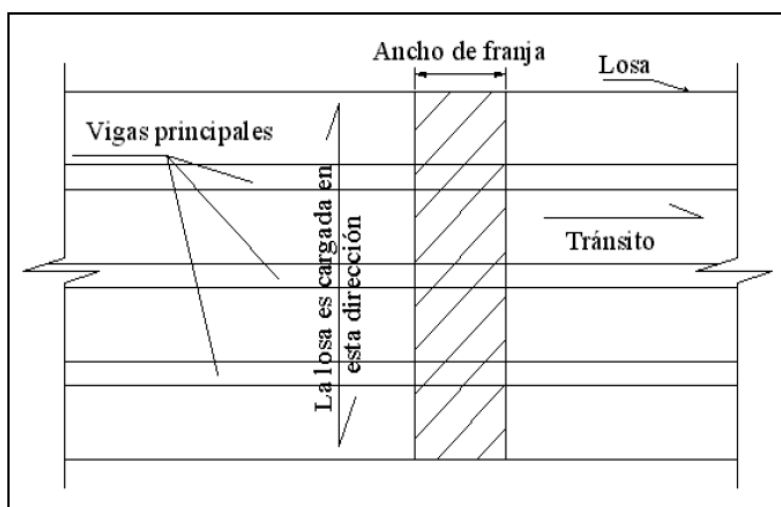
Ancho de franjas en losas cargadas transversalmente al tránsito.
